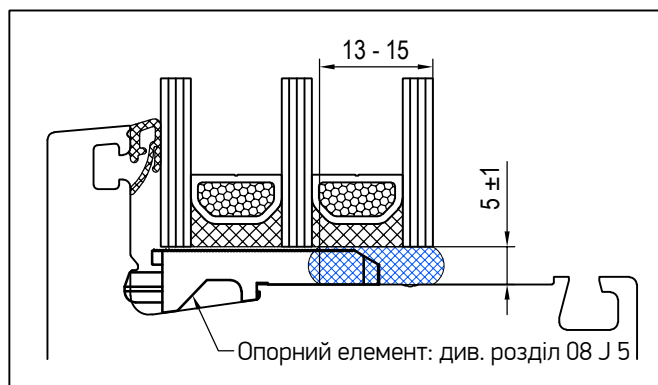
Двокамерний склопакет: площа склеювання / зазор для склеювання
